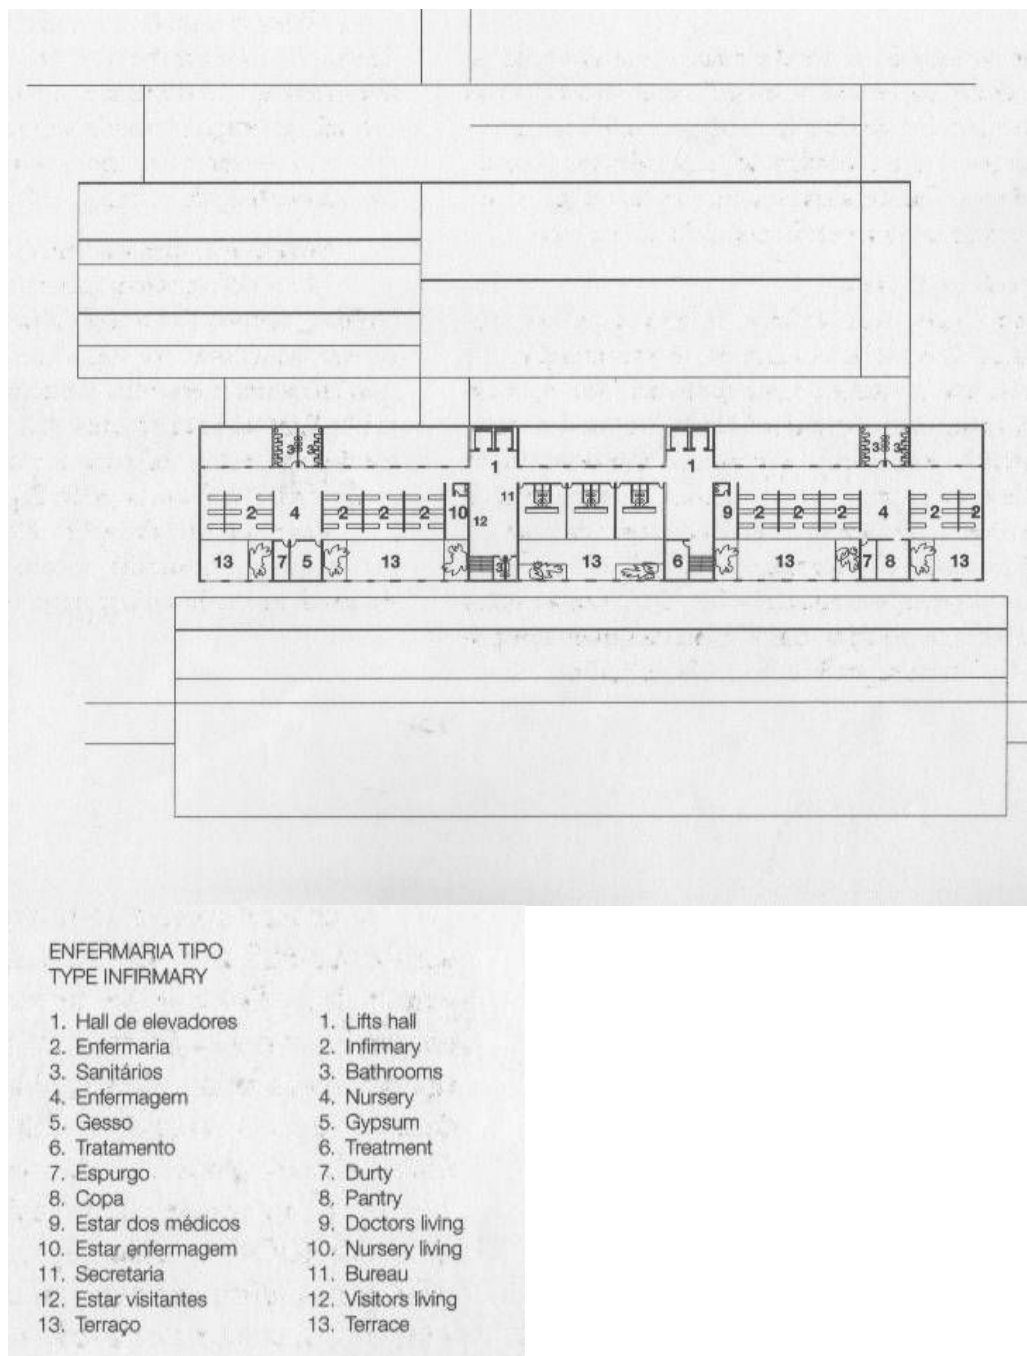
Planta Baixa do pavimento tipo (LATORRACA, 1999).
